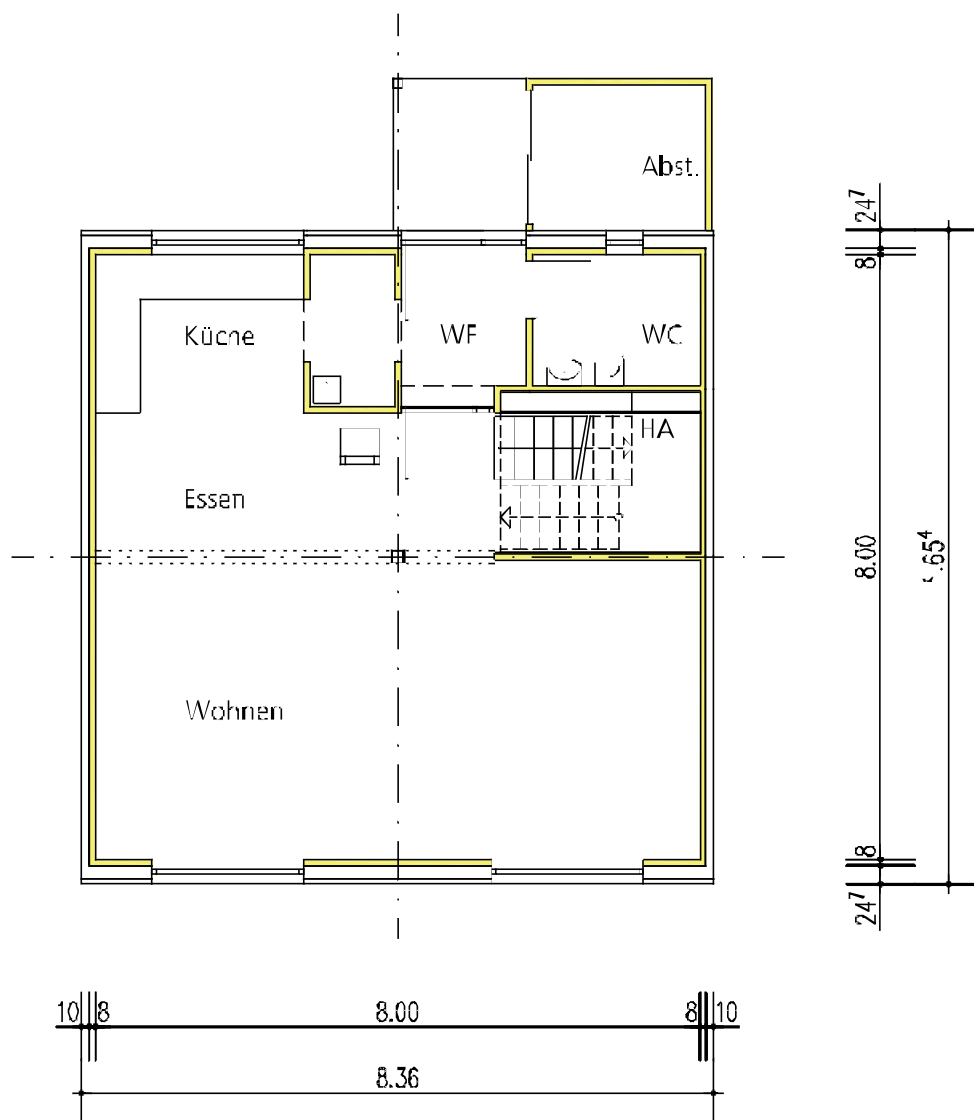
Grundriss EG, M 1:100
